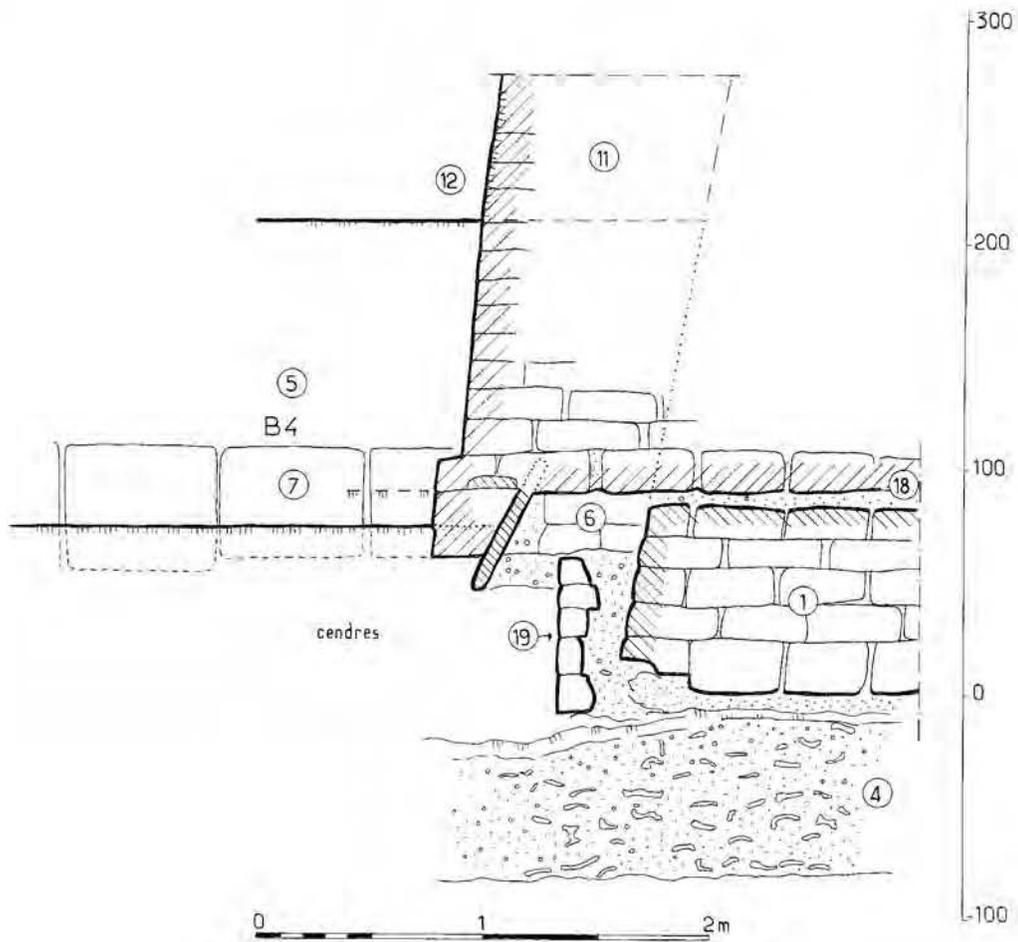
Coupe seconde tranchée (face nord du bastion 4).
